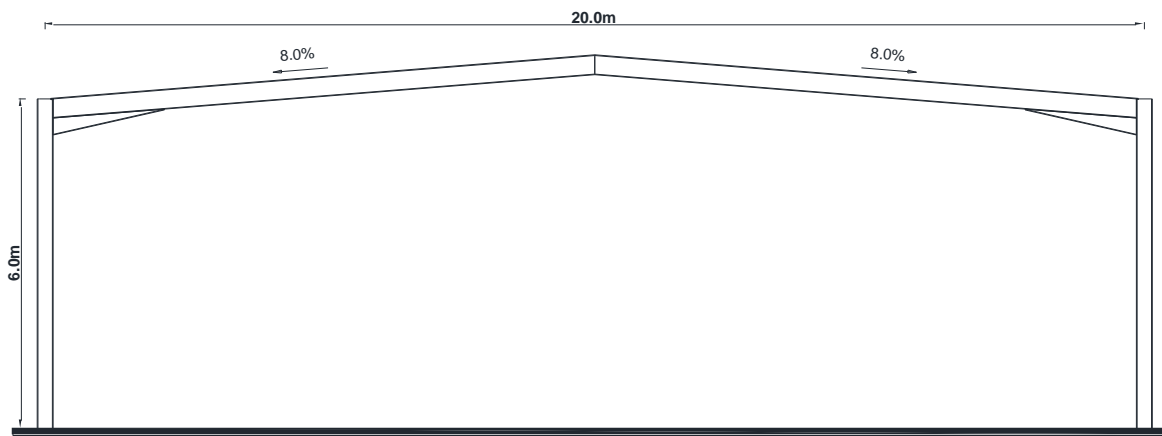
Corte transversal tipo do pavilhão industrial e comercial proposto
